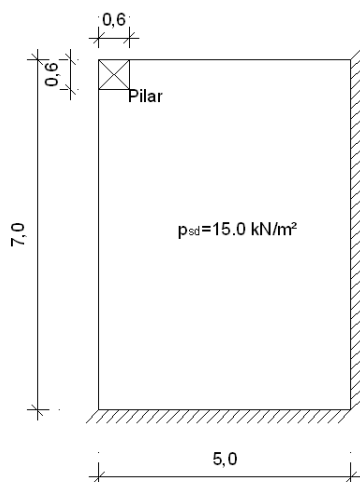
Laje encastrada em 2 bordos e apoiada num pilar
